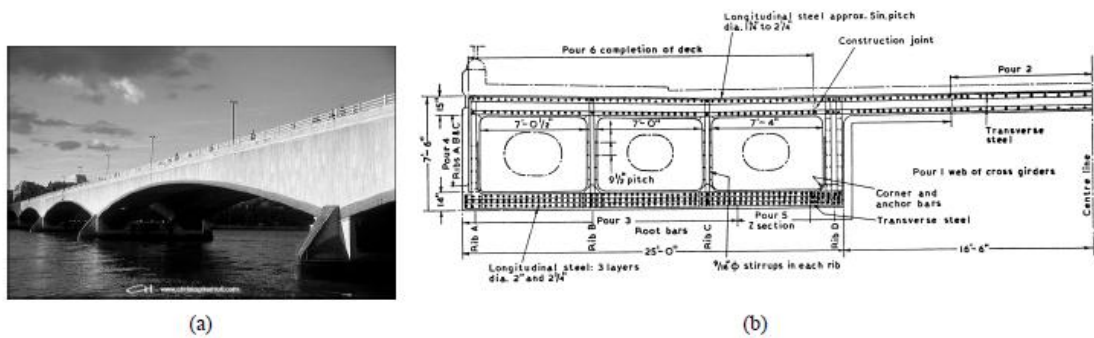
Vista e corte transversal do tabuleiro da Ponte Waterloo [22]
